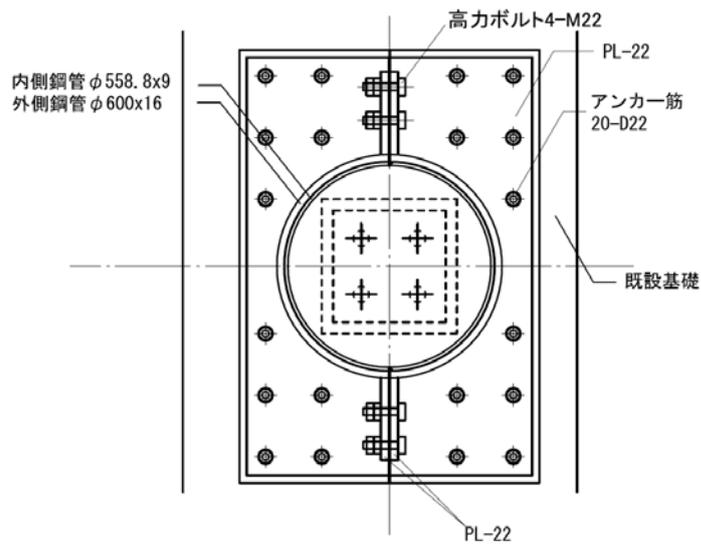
補強鋼管とあと施工アンカー詳細 (伏図)
